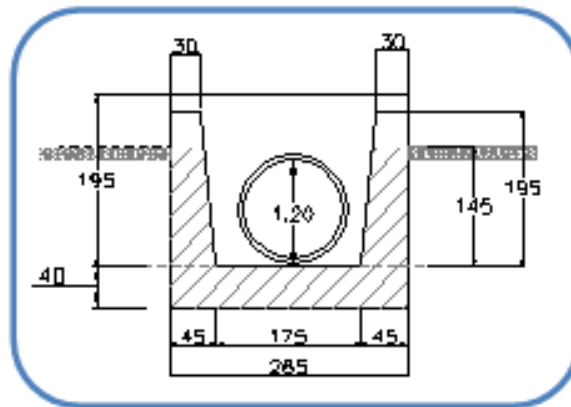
Losa de concreto armado para librar una obra de drenaje mayor.
